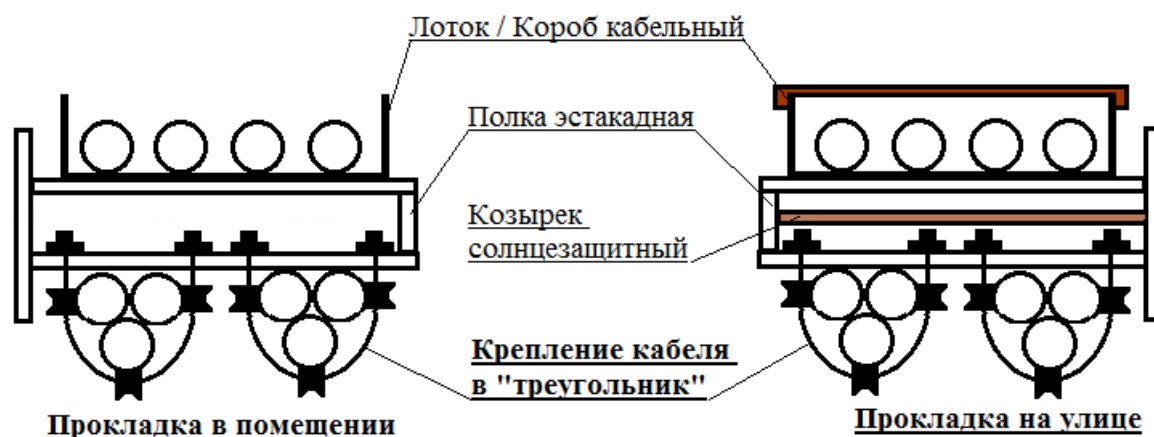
Прокладка силовых кабелей в помещении и на улице
